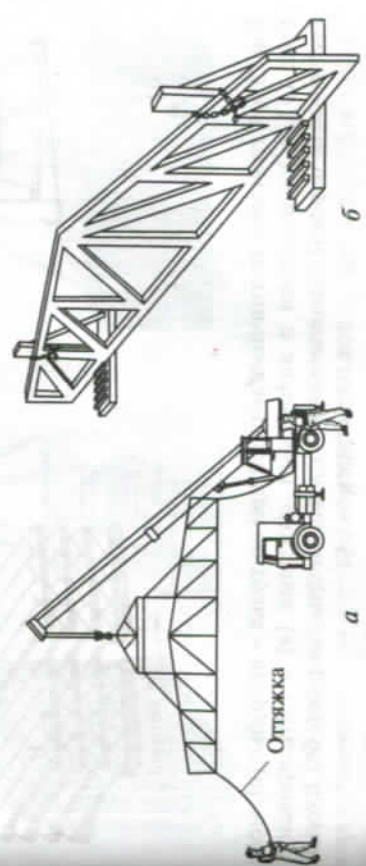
Строповка (а) и складирование ферм на металлических опорах (б)
